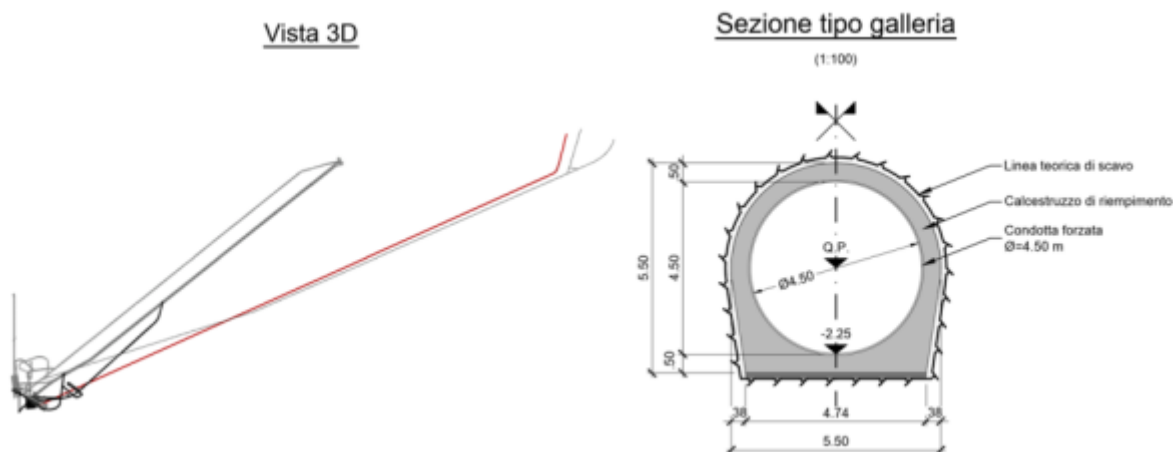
Nuova galleria forzata di scarico/aspirazione sulla derivazione Piaganini – vista 3D e sezione tipo
